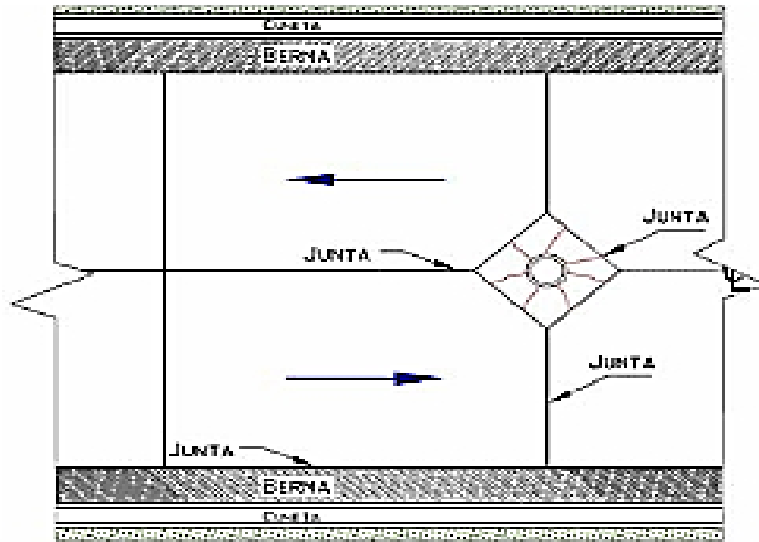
Características de las grietas en pozos de inspección.
